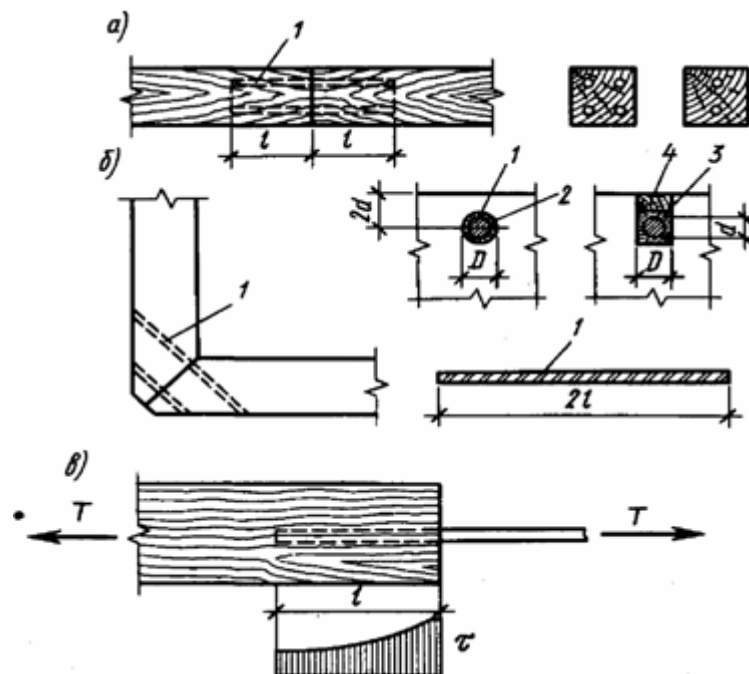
З'єднання на вклеєних стержнях: а — повздовжньо вклеєні; б — похило вклеєні; в — схема роботи; 1-арматурний стержень; 2-отвір; 3 — паз; 4 — рейка
